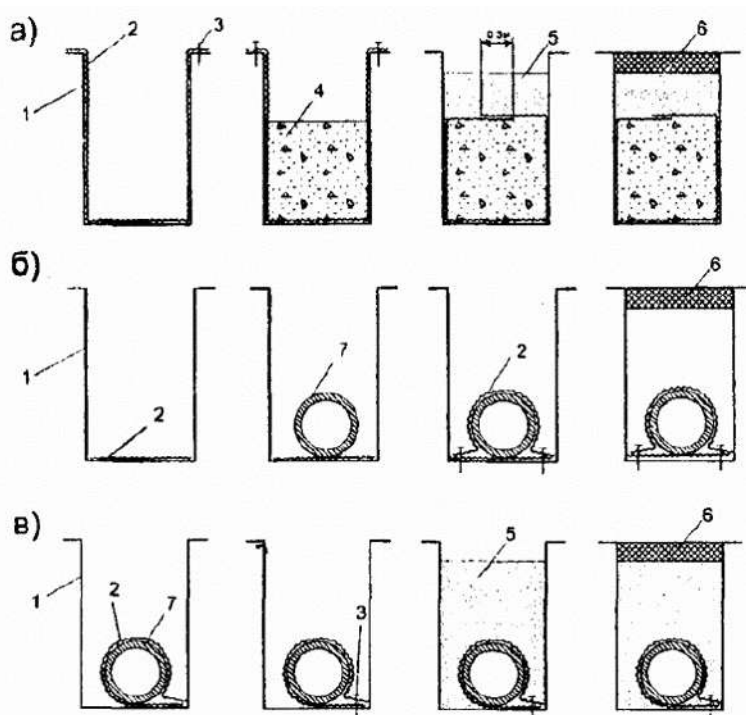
Порядок выполнения работ при устройстве траншейного дренажа:
